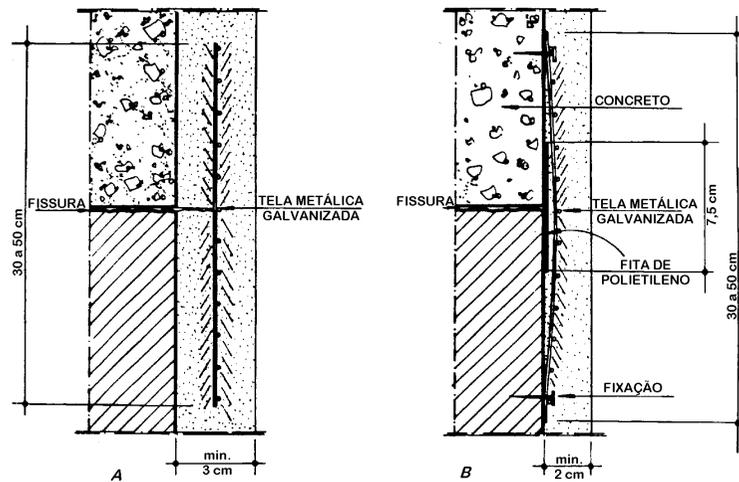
Reforço do revestimento com tela: argamassa armada e ponte de transmissão
